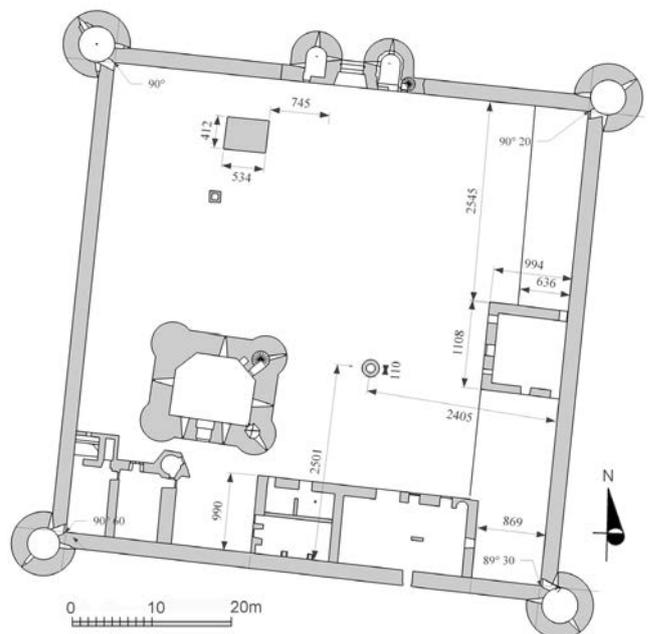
Dordives (Loiret) château de Mez-le-Maréchal : plan général (Les Amis du Mez)
